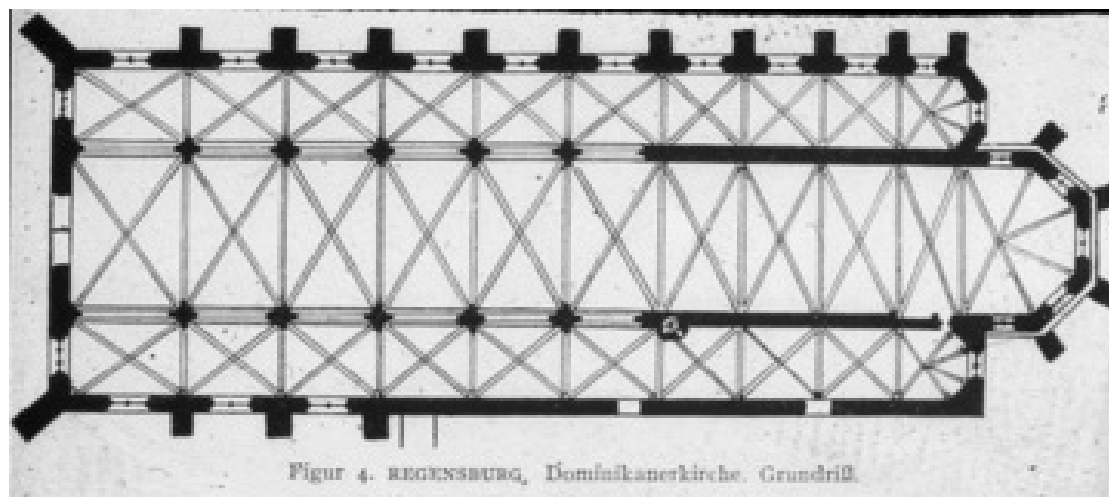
Grundrissplan der Dominikanerkirche in Regensburg, 1243–1275
